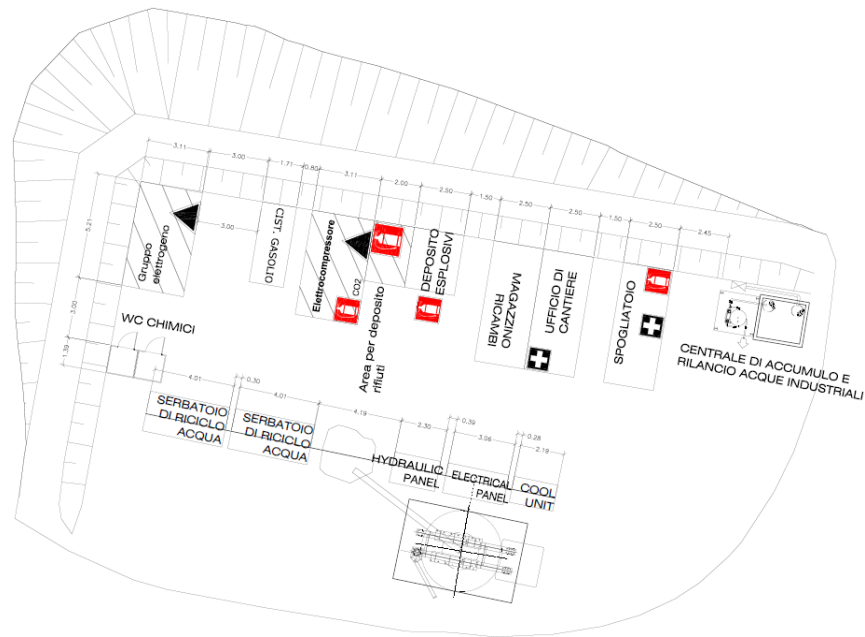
Cantiere pozzo: fase 1 – scavo con rise boring
